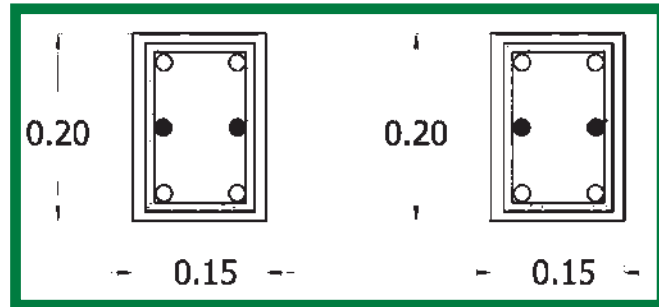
Creada por VMMG, muestra las medidas de las trabes de desplante y de cerramiento a utilizar en el proyecto, ver ubicación en el plano estructural.
